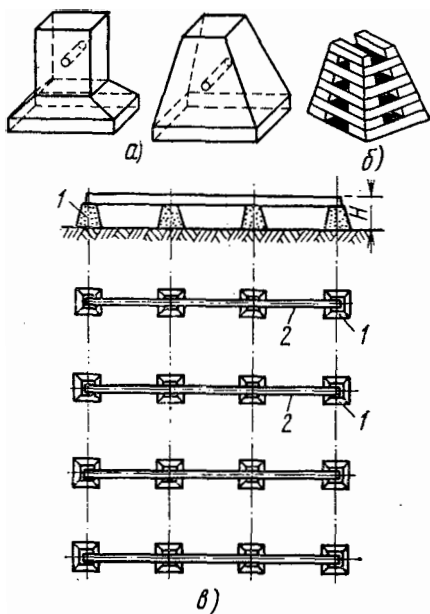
Устройство штабельного фундамента из переносных элементов:
